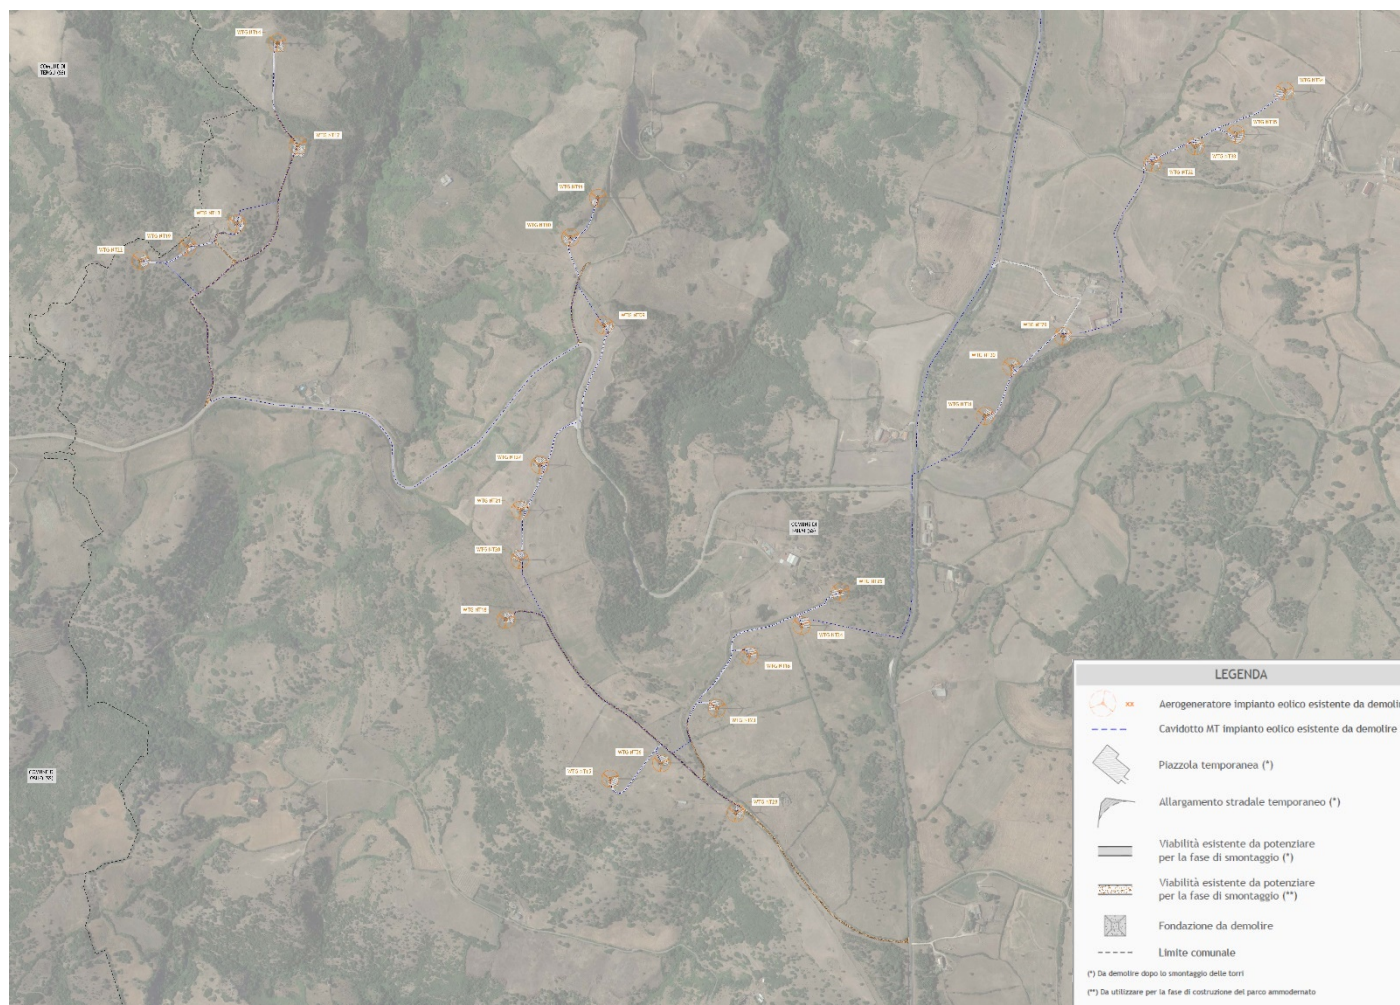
Stralcio della planimetria con individuazione dell’impianto eolico esistente su ortofoto
